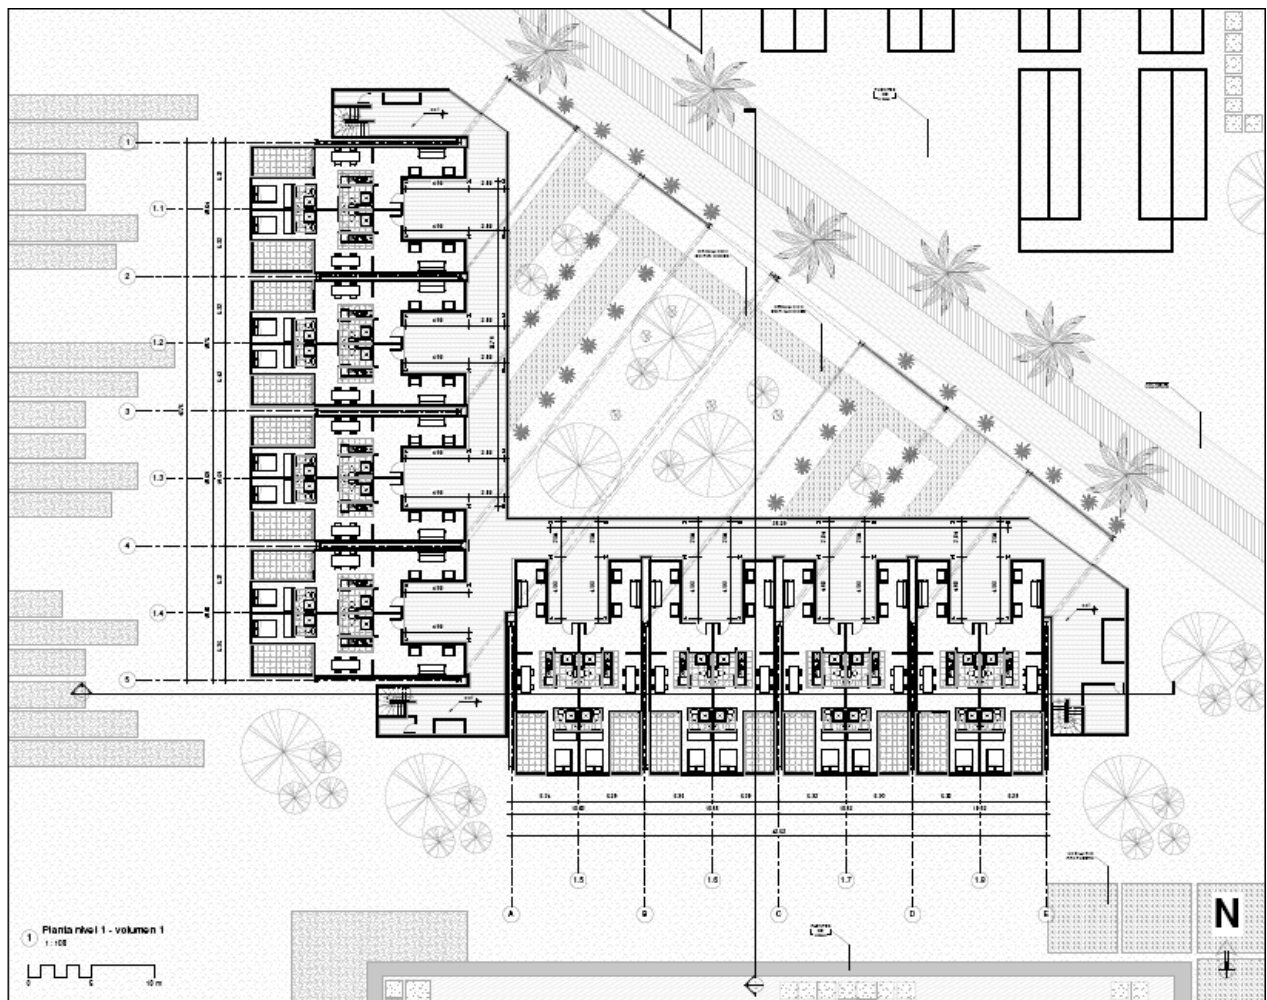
Anexo de planta de primer piso volumen 1 - Fuente propia.
